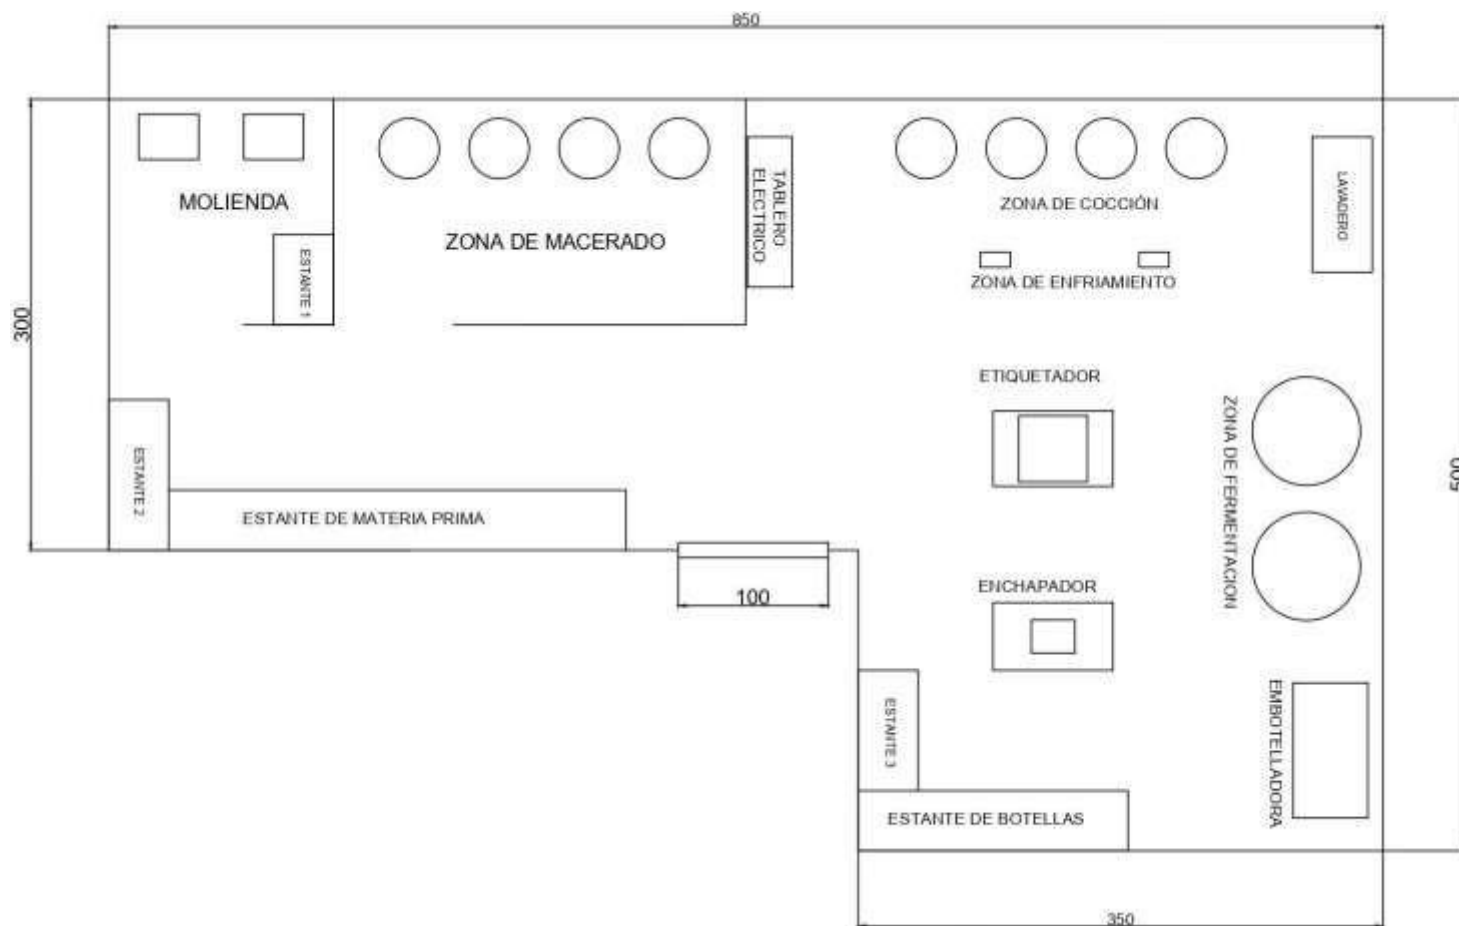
LAYOUT DE PLANTA ACTUAL
